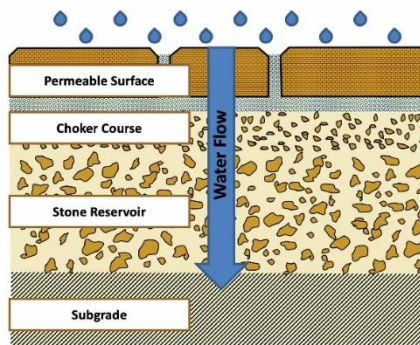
Jenis-Jenis Material *Permeable Pavement
